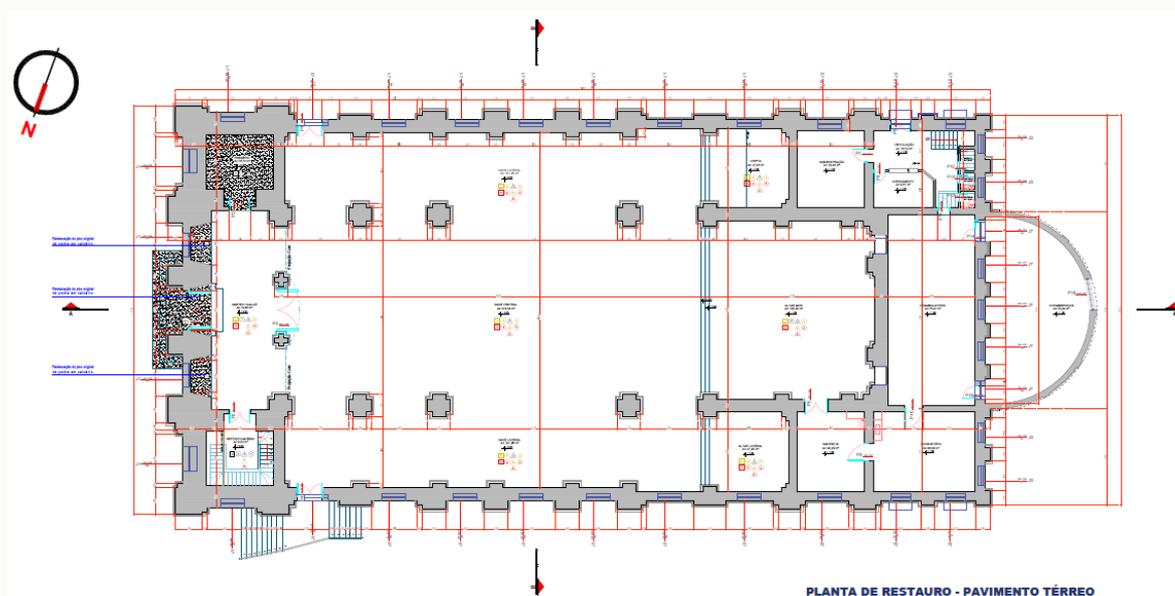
Planta de restauro do pavimento térreo da Catedral de Santana em 2022, por Leila Cristina Marques.
